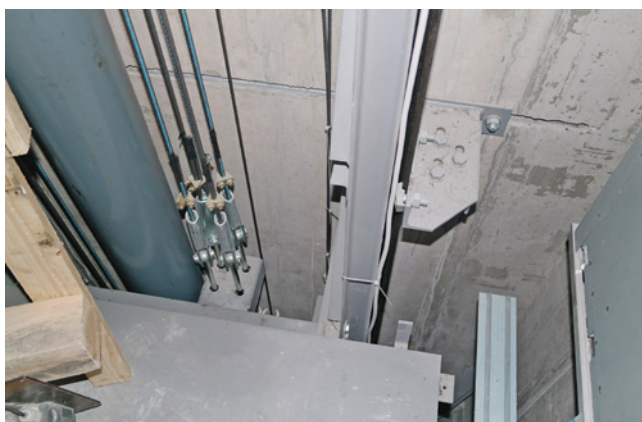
Aufzugsanlage, Kabine im Montagezustand: Blick auf den Kabinenboden mit Kabinenrahmen und Befestigung der Trageile auf Bodenniveau an einem Kragarm
